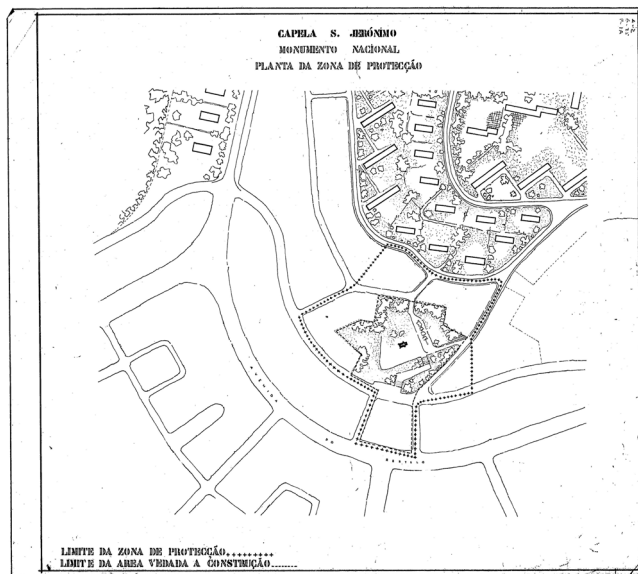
Capela de São Jerónimo. Planta da Zona de Proteção. s.a, s.d.
